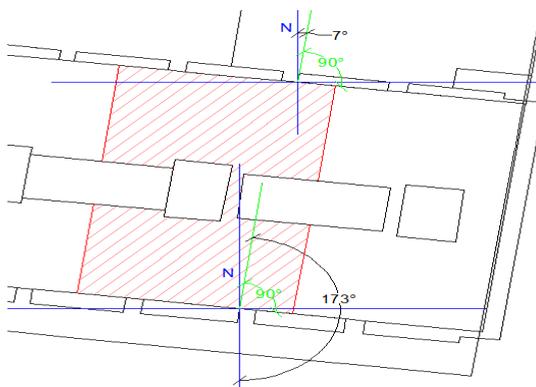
Justificación de orientación de las fachadas de la vivienda
